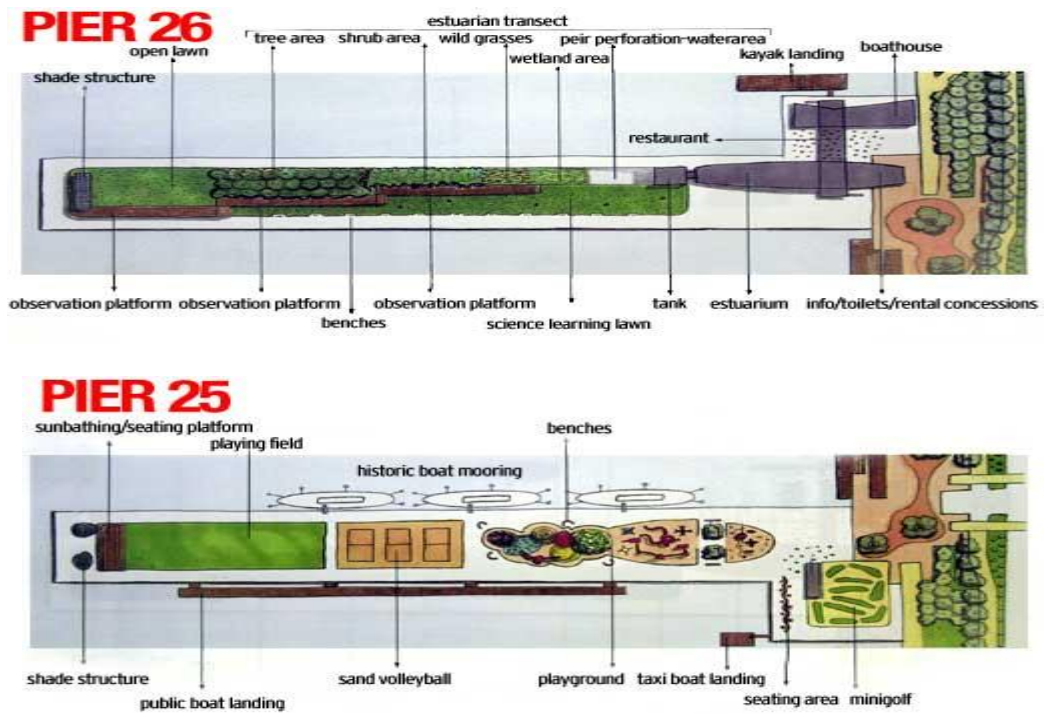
Pier 25 sección recreacional y Pier 26 sección comercial y jardines.
